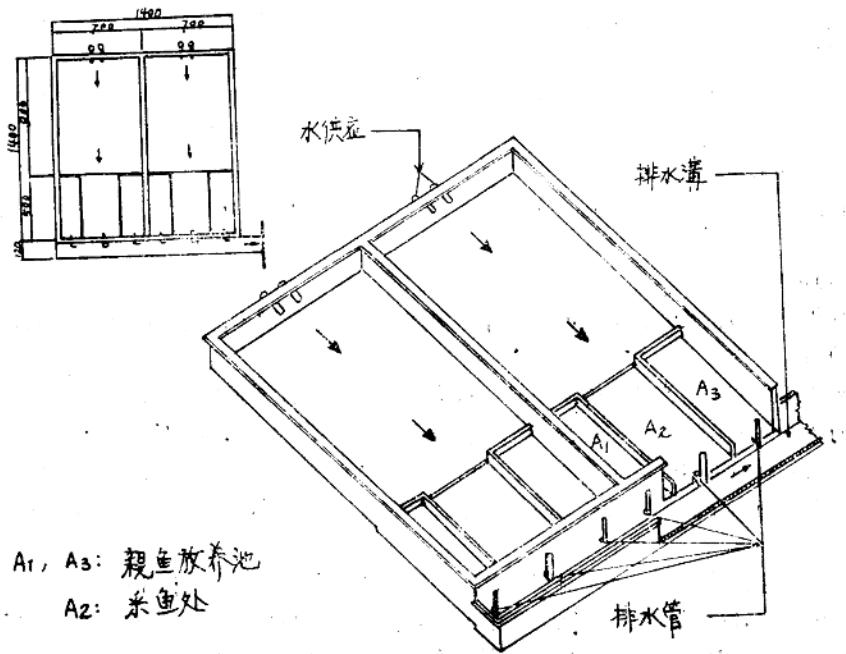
罗非鱼人工繁殖池塘系统的平面图和断面图
